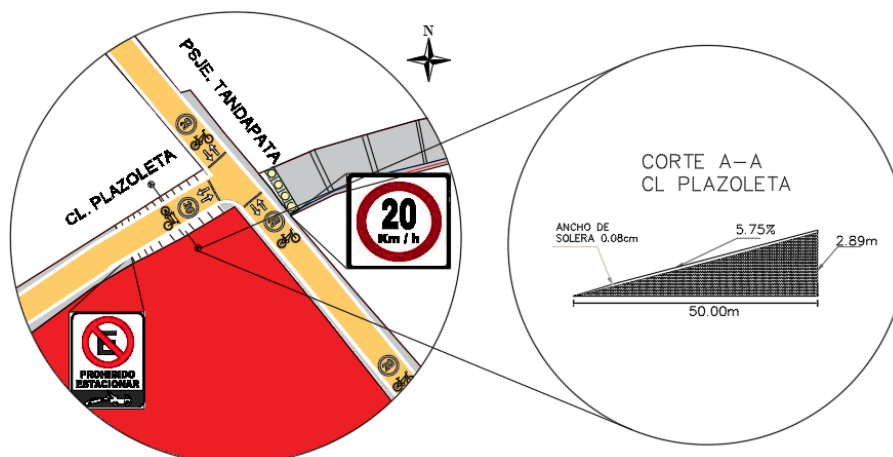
Propuesta en Planta de la calle Plazoleta con Tandapata
